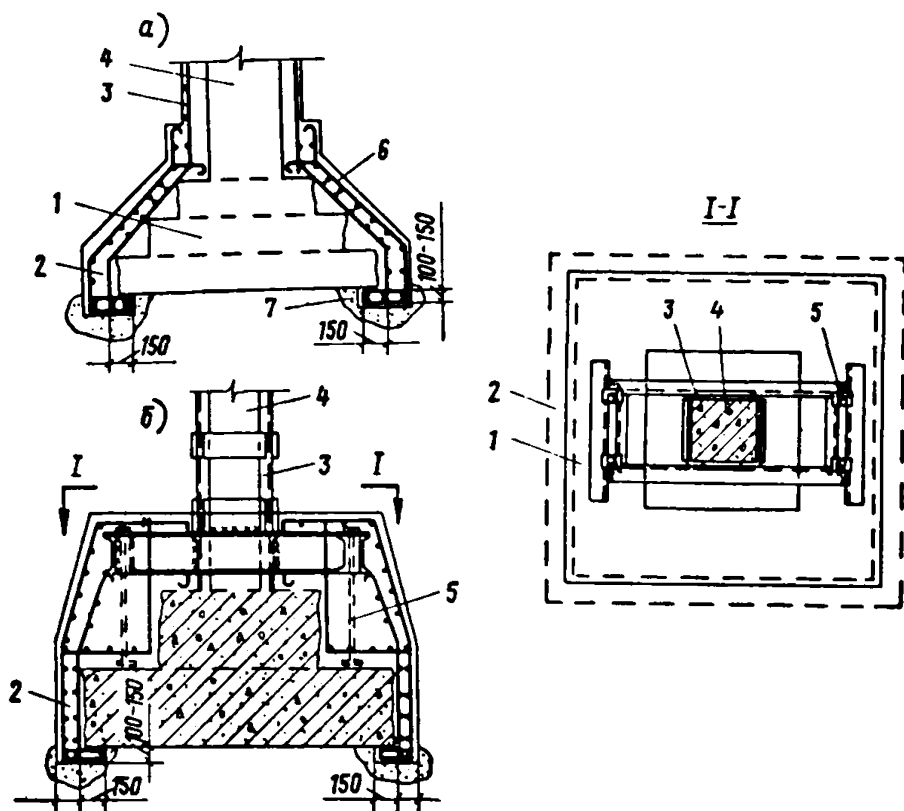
Усиление отдельных фундаментов железобетонной рубашкой
